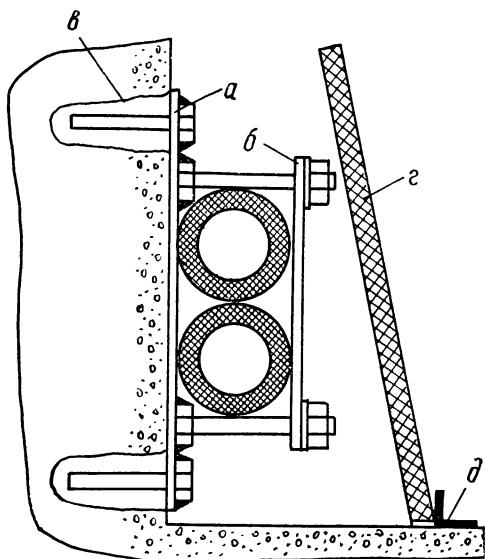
Крепление трубопроводов к стене: а — болт; б — планка; в — гипс; з — панель; д — уголок
